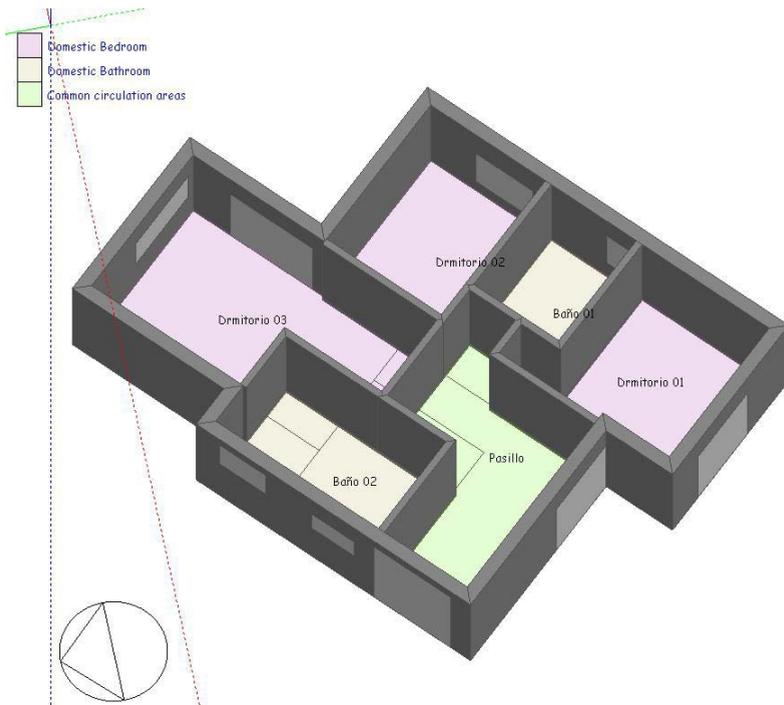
Primera Planta de nuestra vivienda. Fuente propia DesignBuilder
